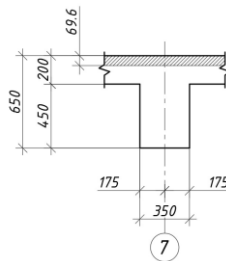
Граница сжатой зоны на тавровом сечении
